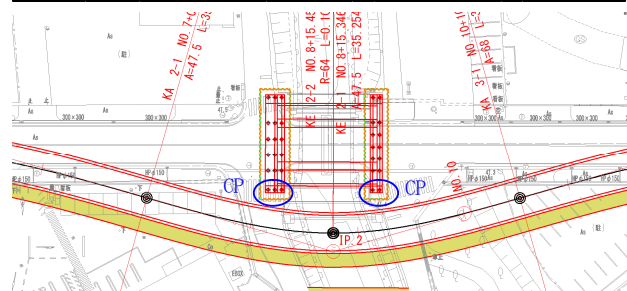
迂回路平面図(第1案：一括施工上流側迂回路案)
